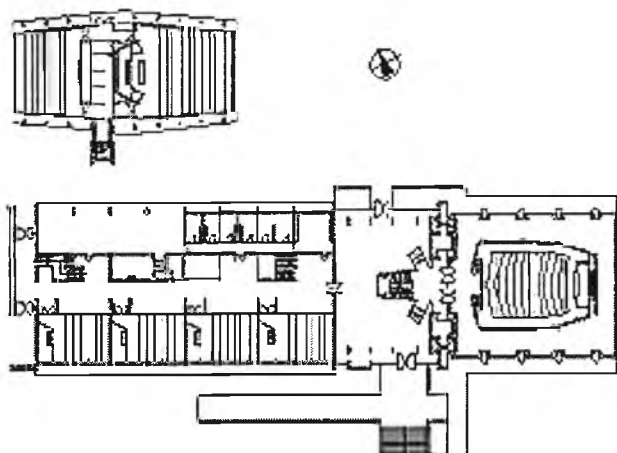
C.R. Swart-gebou – Plan grondvloer
